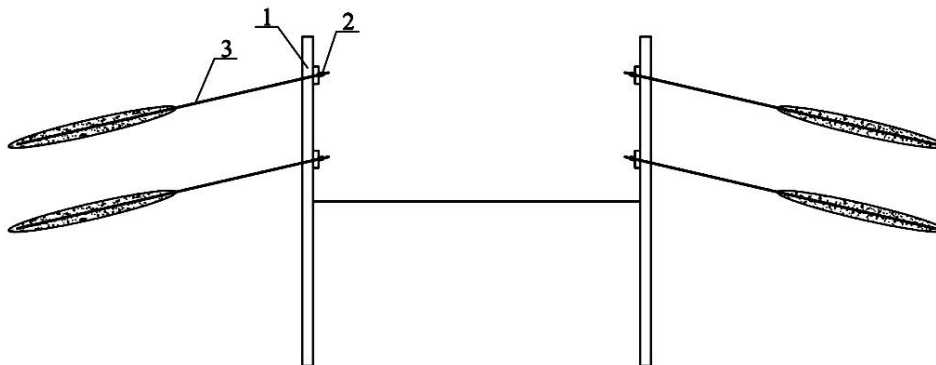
Крепление стен глубокого котлована грунтовыми анкерами:
